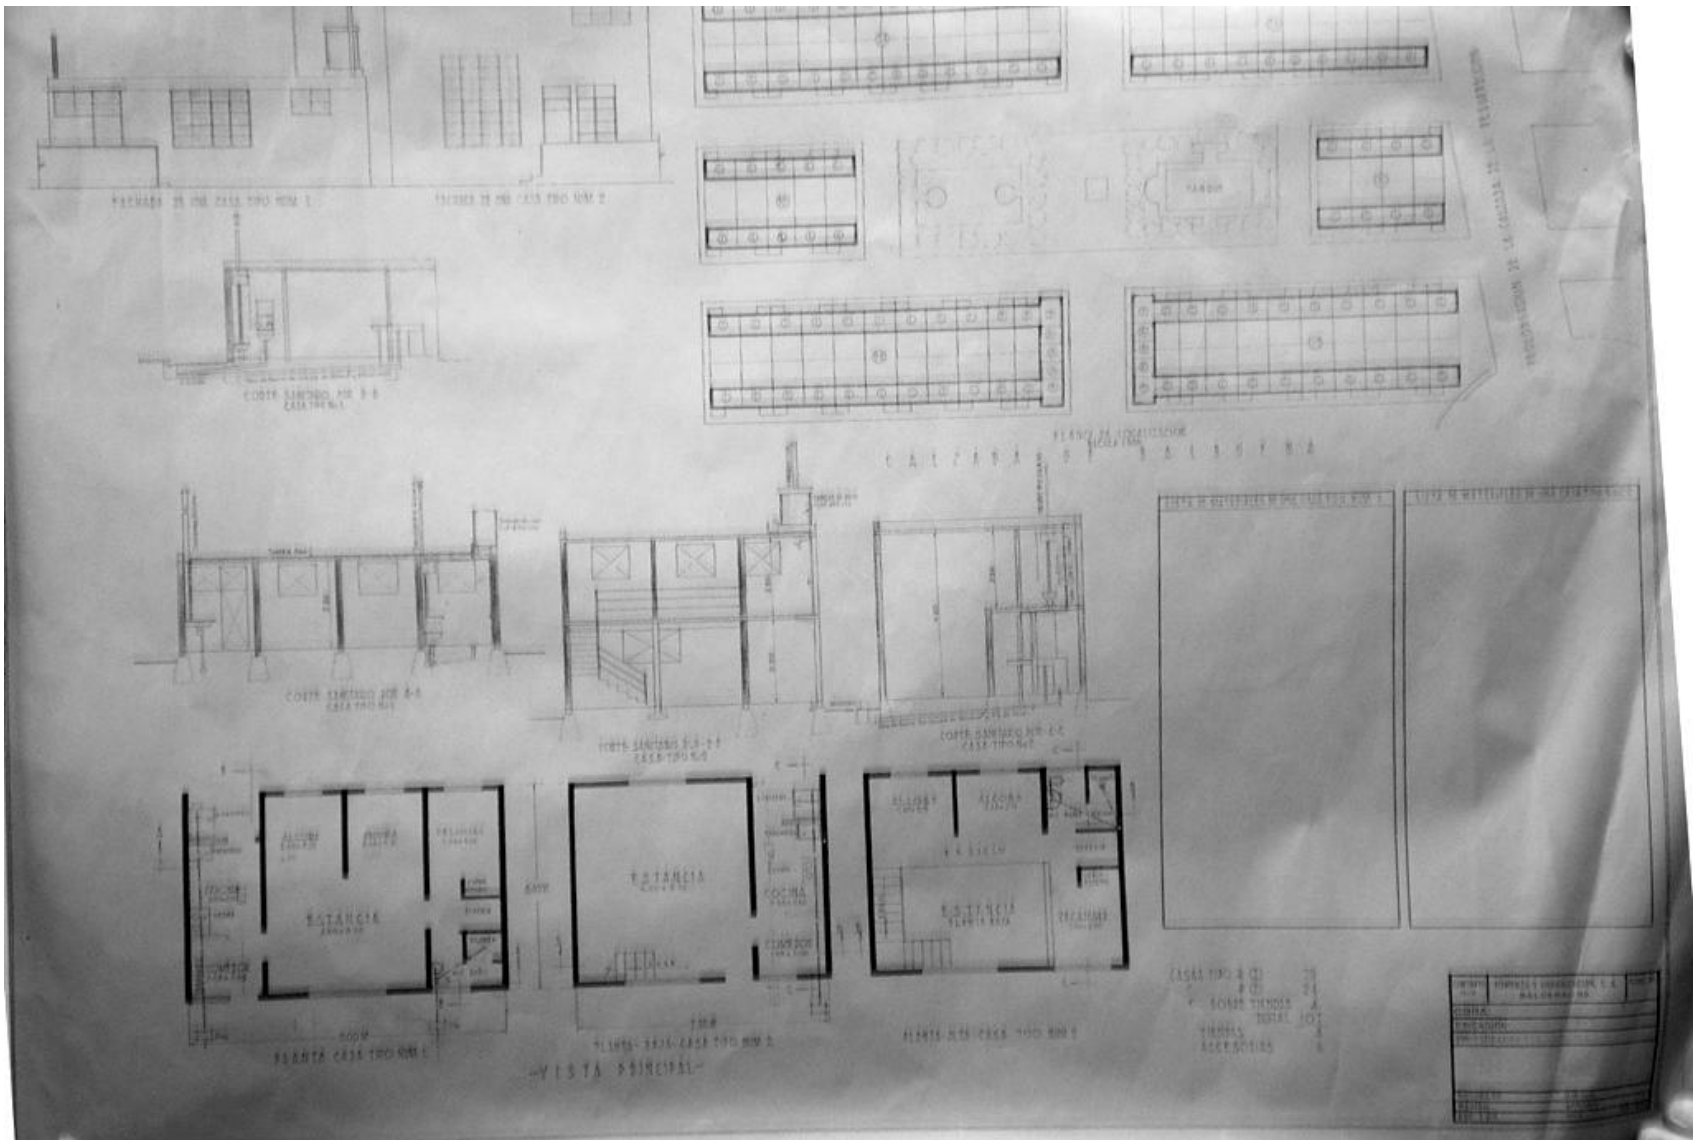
Plano arquitectónico de la Unidad de Vivienda Obrera Balbuena de la Casa Tipo Dos.
